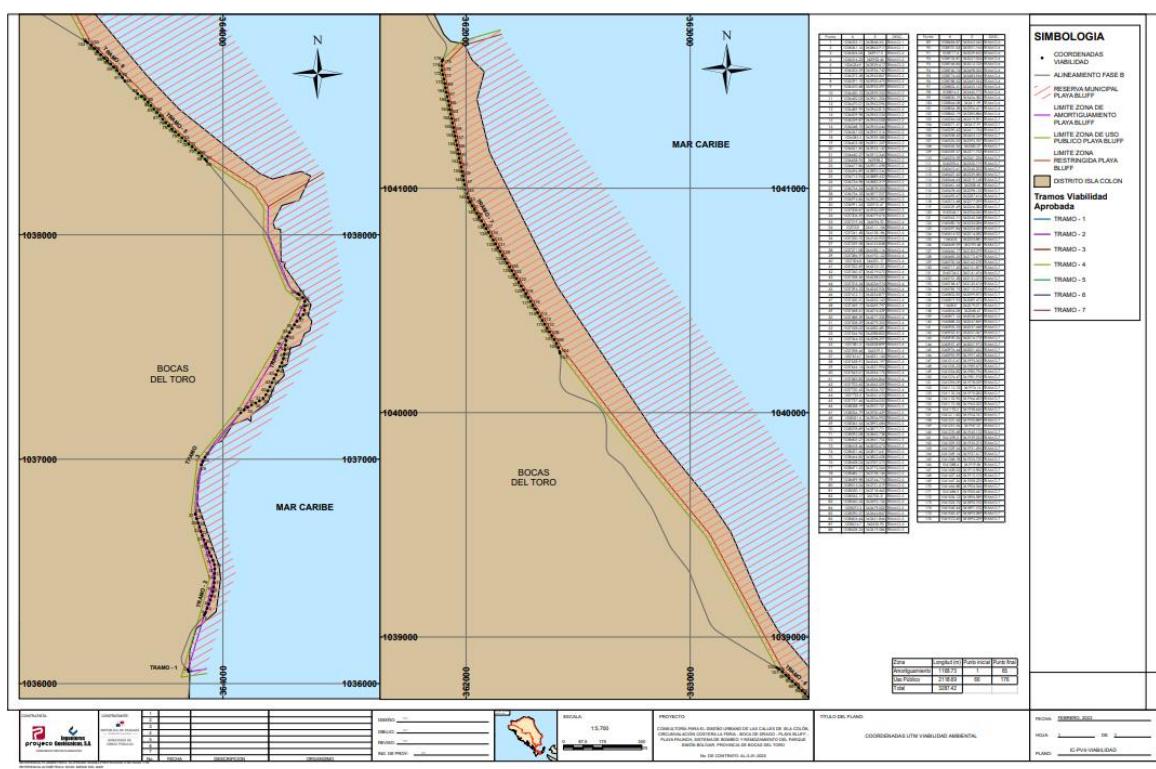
Plano de tramo de Viabilidad con coordenadas UTM a cada 20 m (ver Anexo 13)
